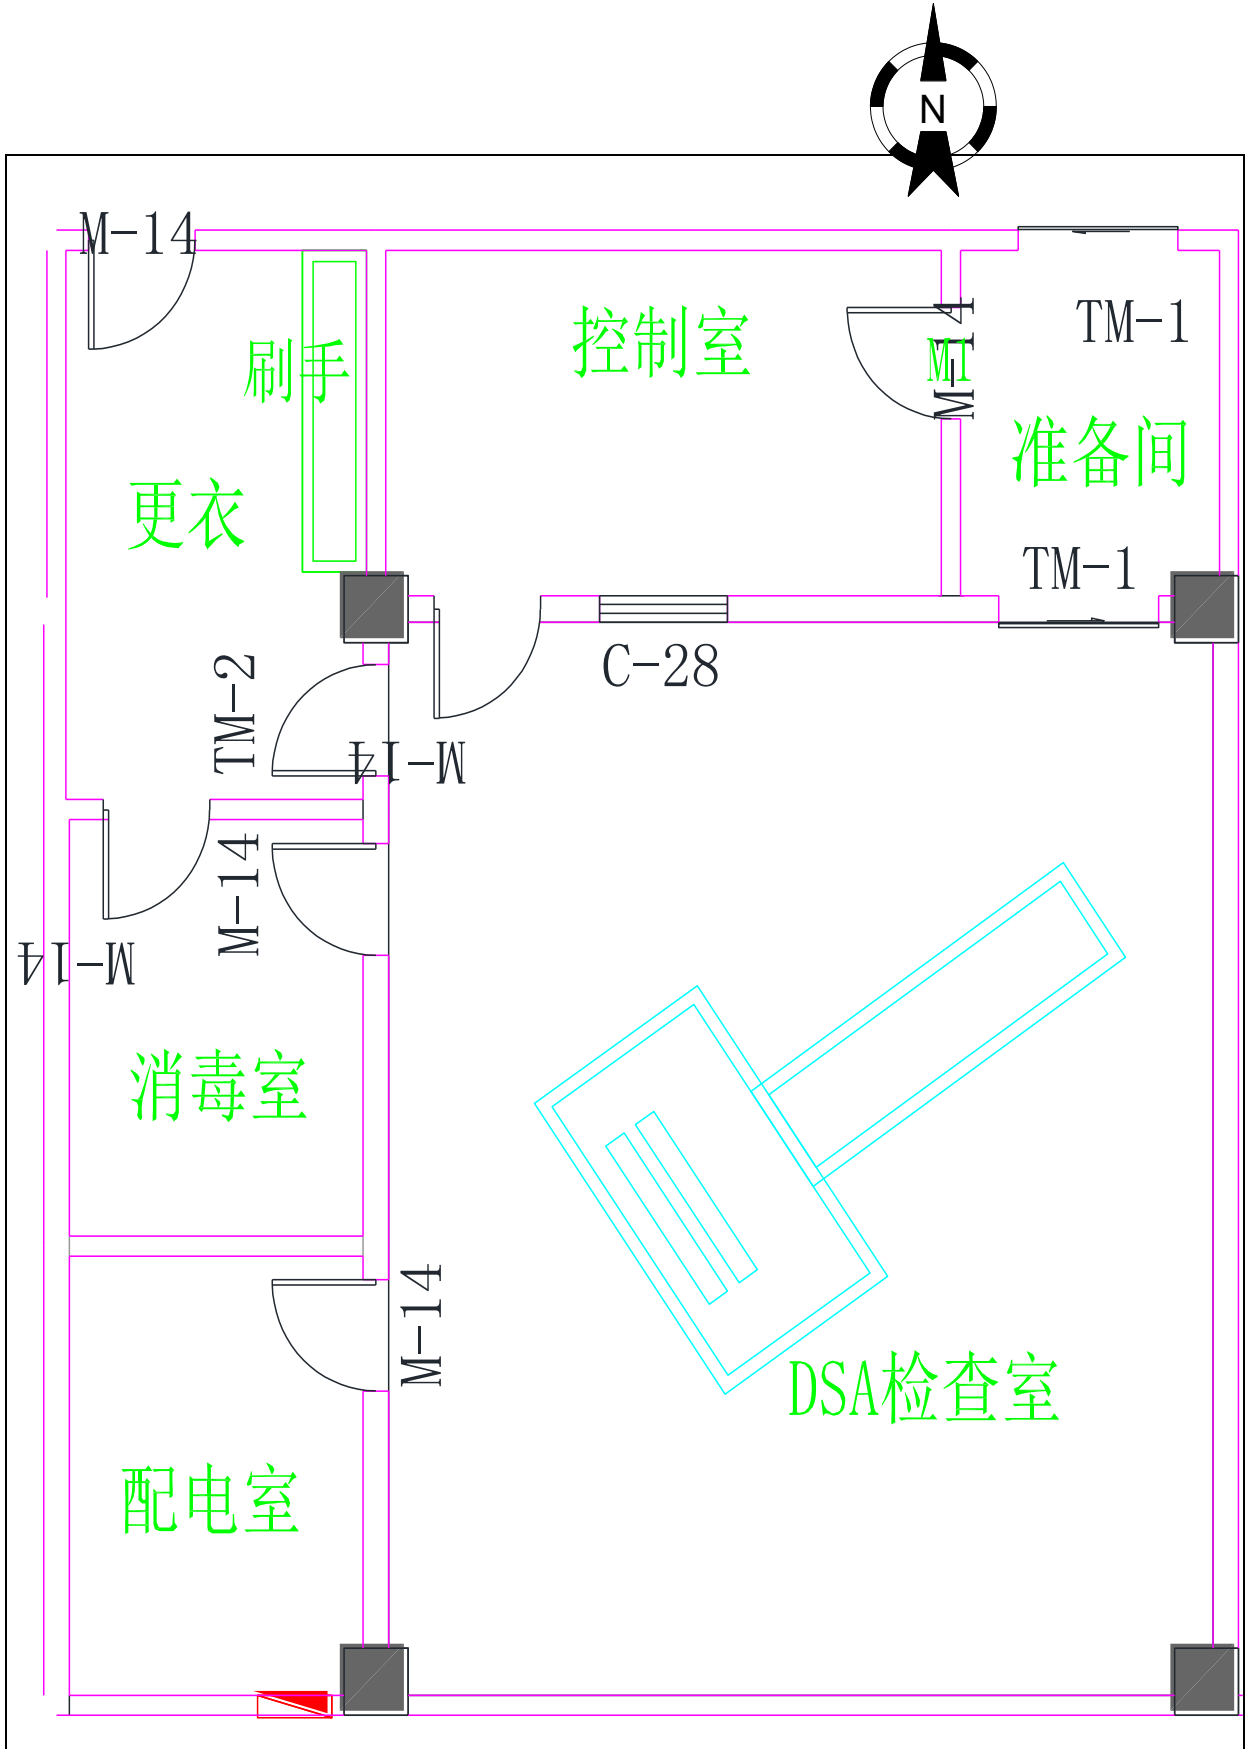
宜兴市中医医院 DSA 机房平面布置示意图
